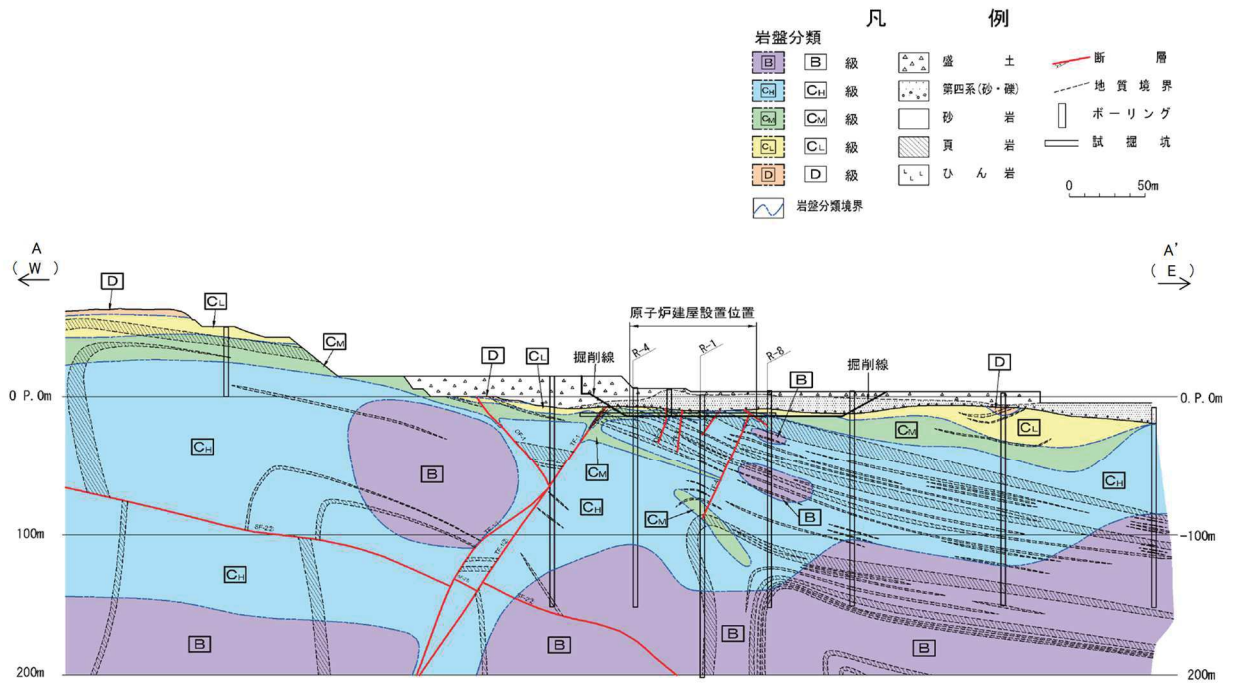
地質断面図 (第 2 号機原子炉建屋中央, 東西方向) (A-A' 断面)
